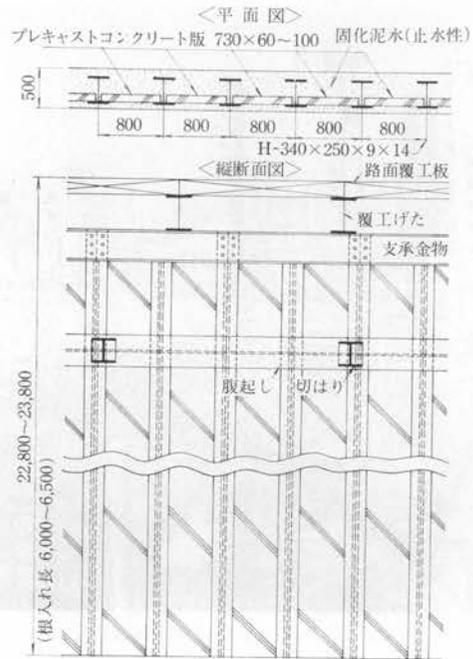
赤坂工区プレキャストコンクリート板使用による連続地中壁施工計画図
